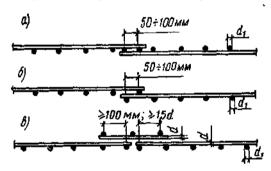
Стыки сварных сеток внахлестку (без сварки) в направлении рабочей арматуры при выполнении последней из стержней периодического профиля
